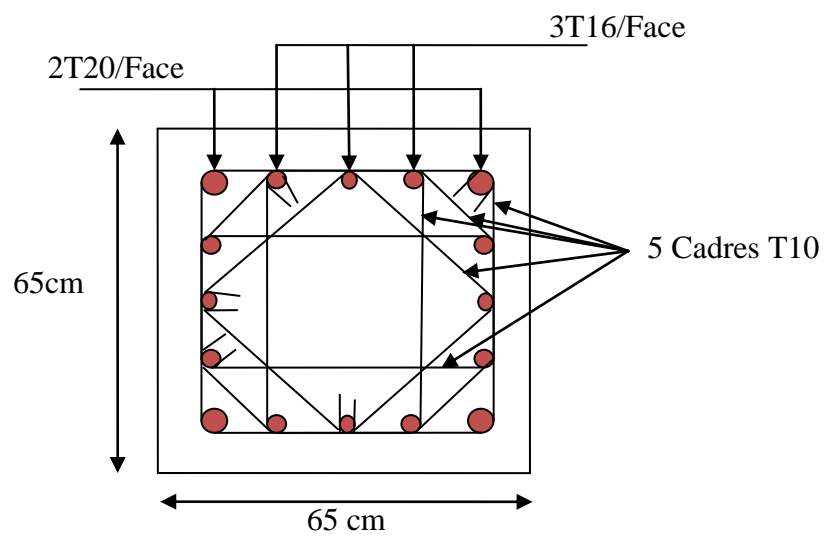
Schéma de ferrailage des poteaux d'E.S.3, RDC
